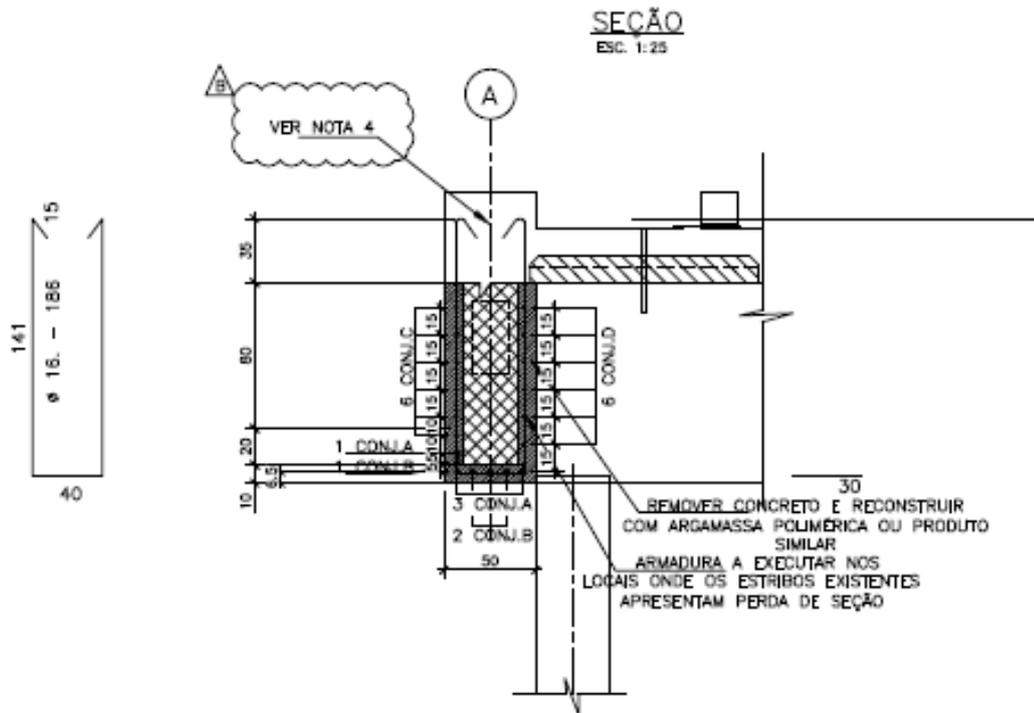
Detalhe da recuperação estrutural da viga de paramento
